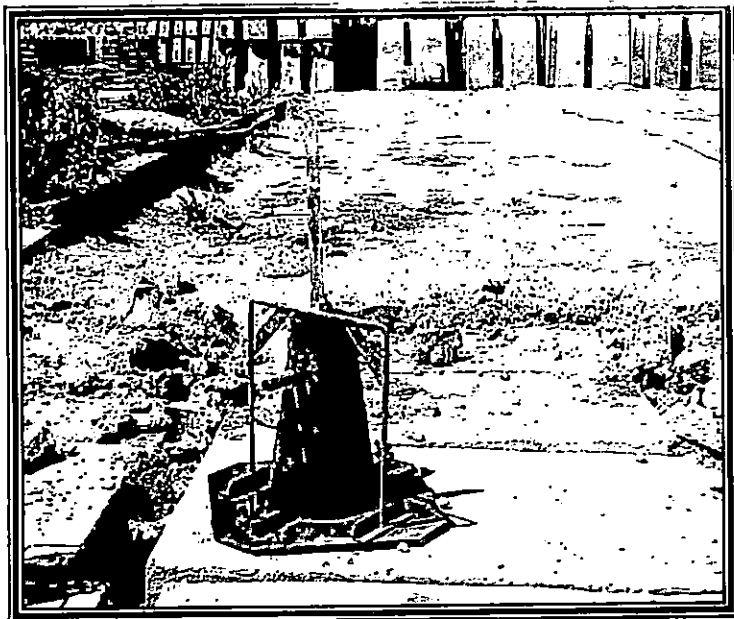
Cône d'Abrams (Les essais d'affaissement)
